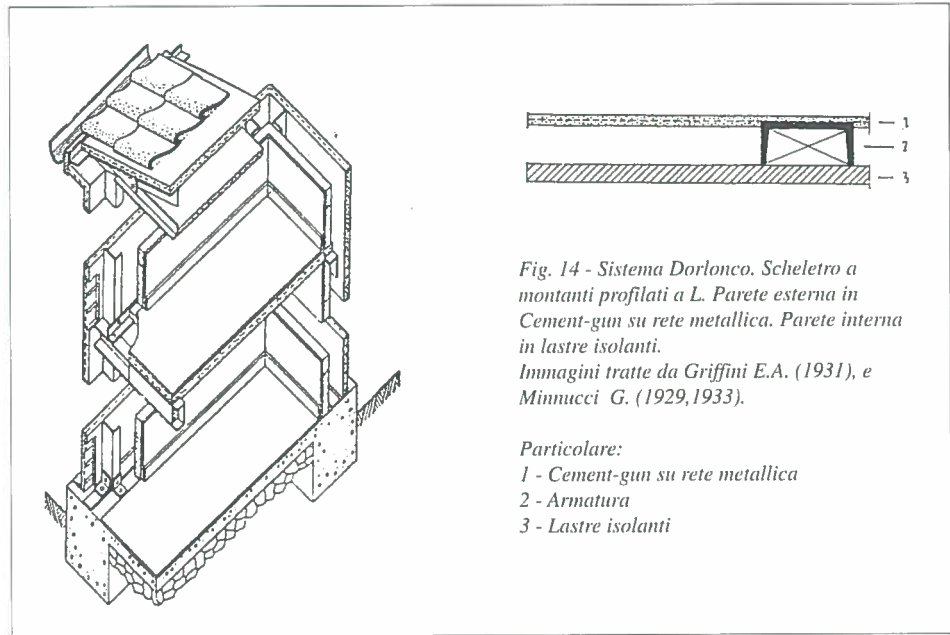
Sistema Dorlonco. Scheletro a montanti profilati a L. Parete esterna in Cement-gun su rete metallica. Parete interna in lastre isolanti. Immagini tratte da Griffini E.A. (1931), e Minnucci G. (1929,1933).
